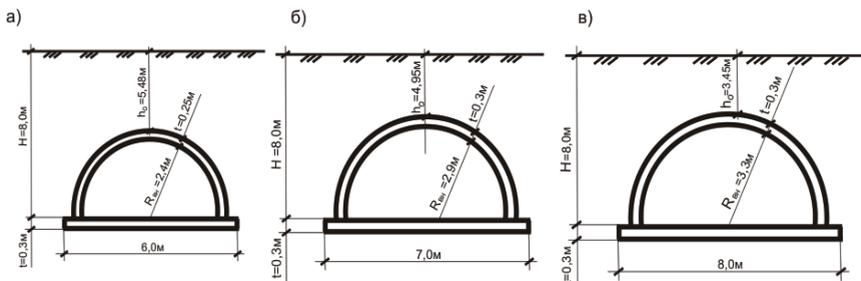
Схемы водопропускных труб шахтных водосборов из сегментных блоков
